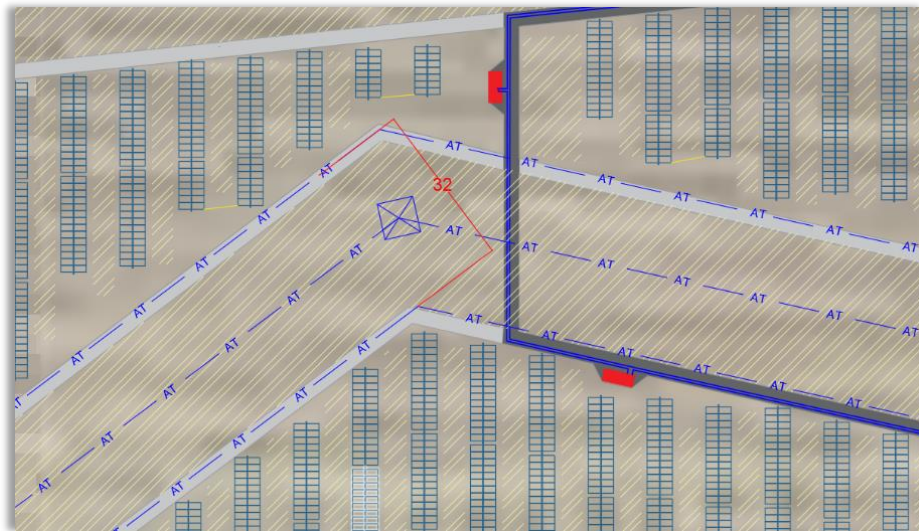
Layout Impianto con indicazione fasce di rispetto elettrodotto AT
